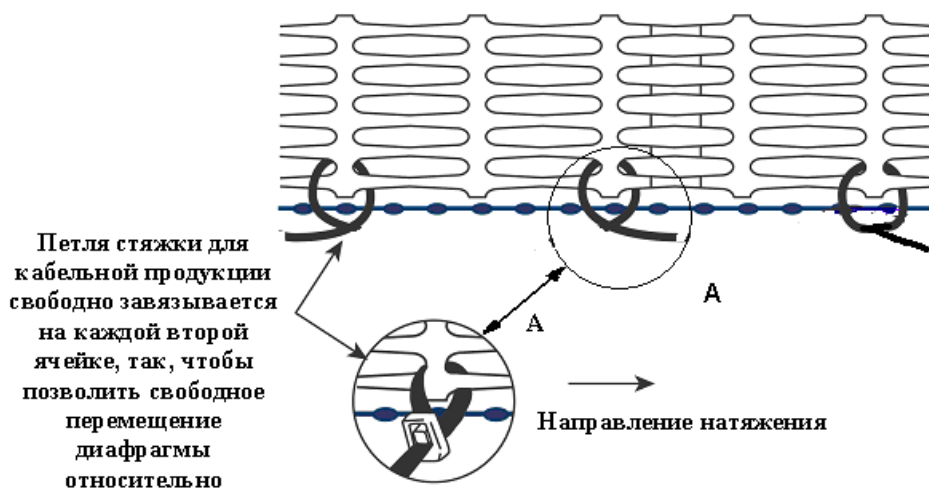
Схема крепления поперечной диафрагмы к базовой георешетке
